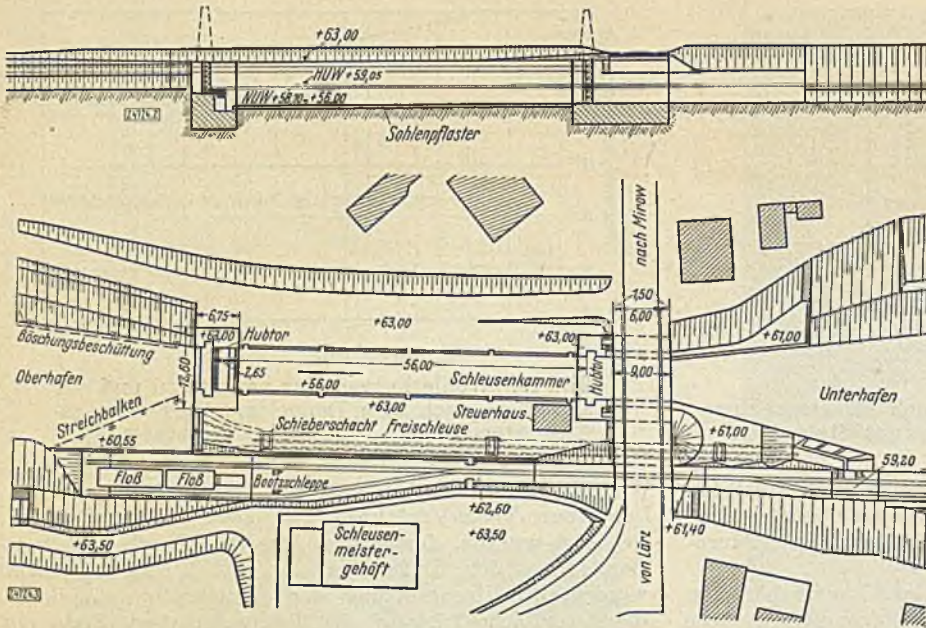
und 3. Längsschnitt und Grundriß des Schleusenbauwerkes bei Mirow.
